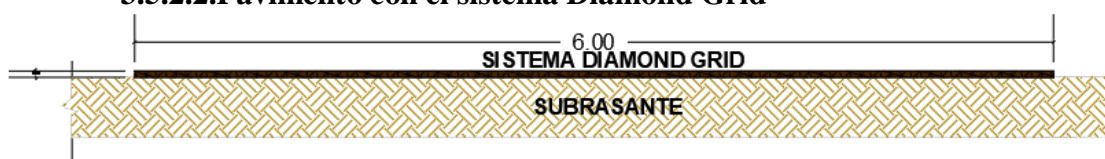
Corte transversal de pavimento con el sistema Diamond Grid
